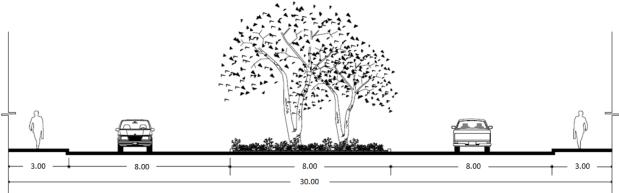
Corte de la avenida central. Elaborado para el proyecto.
